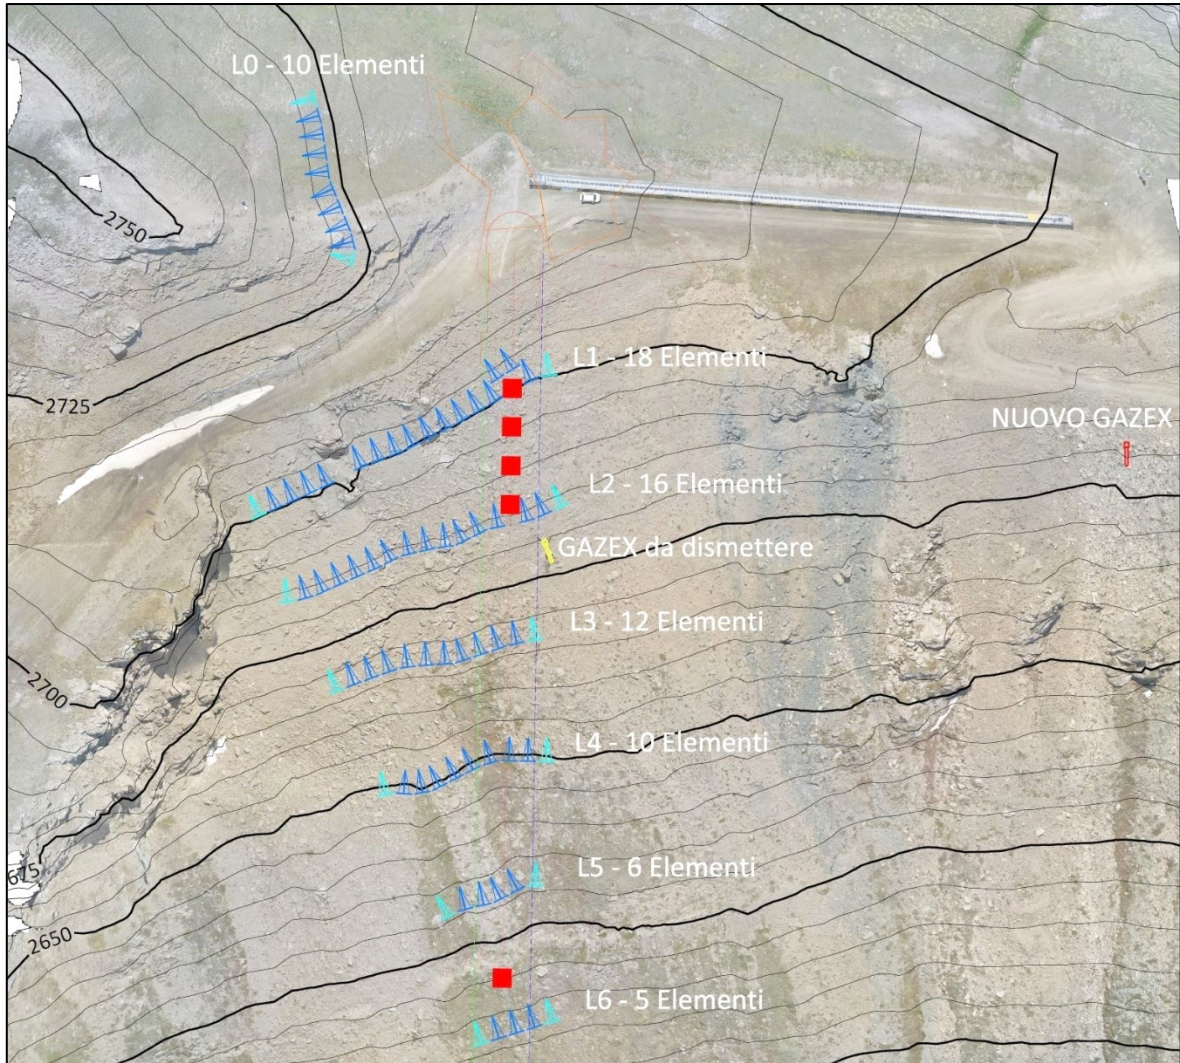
ESTRATTO PLANIMETRIA DI PROGETTO – IMPIANTO PARAVALANGHE
